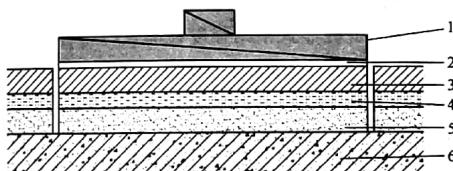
基体不带加强或保温现场粘贴饰面砖试样胶粘标准块示意
